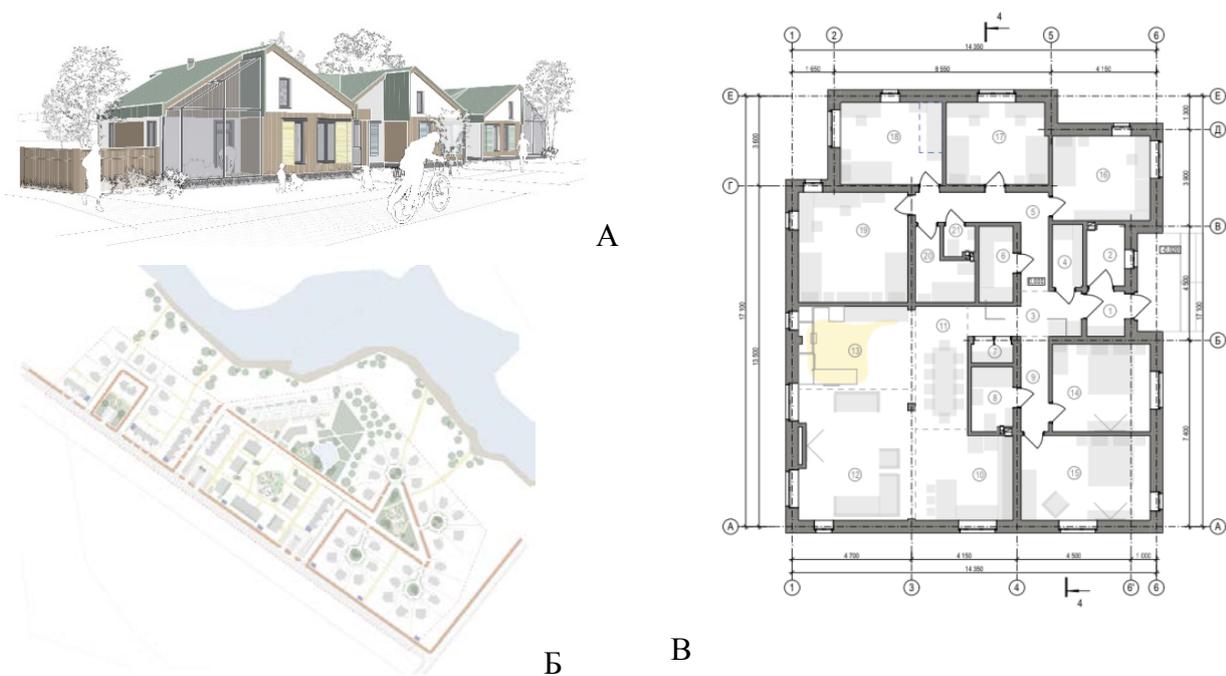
Проект малоэтажного жилого района в г. Азове: А) одноквартирный жилой дом, Б) генплан жилой застройки, В) план жилого дома для семьи с 6 детьми
